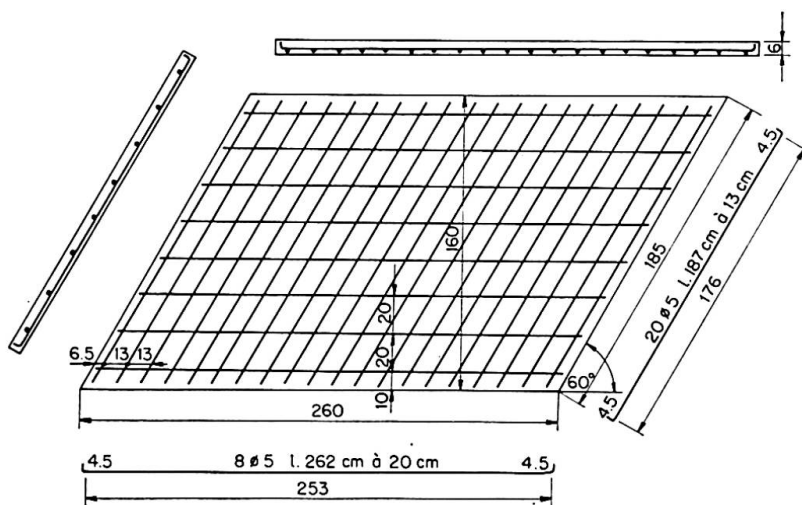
Plan et coupes des dalles d'essai avec les armatures.
